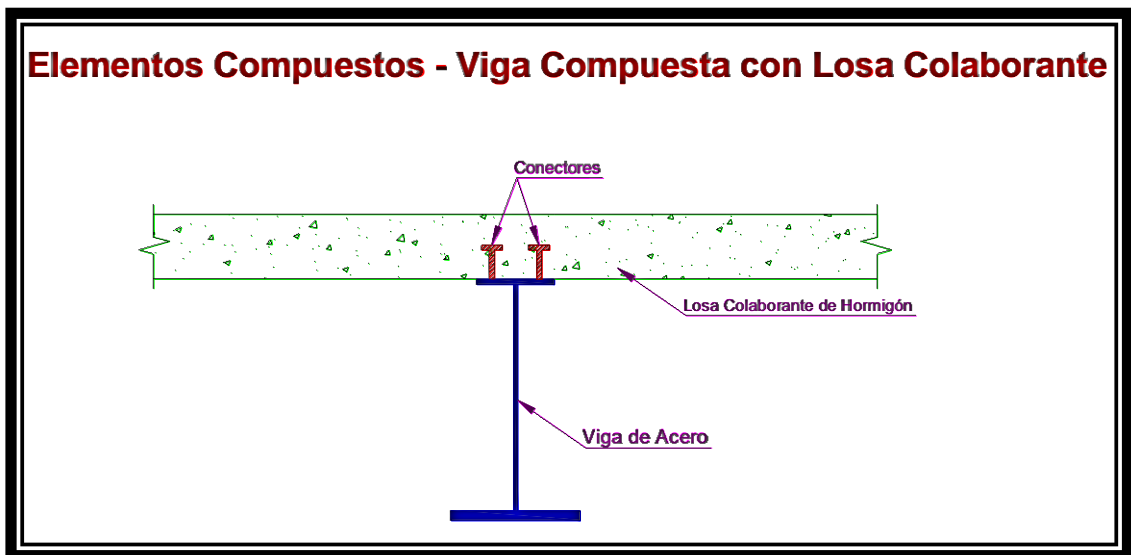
3: Viga Compuesta con Losa Colaborante.
